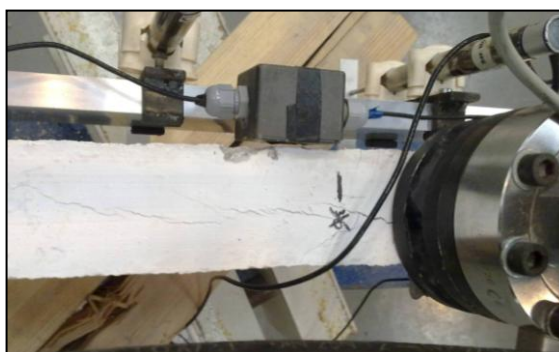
Fissuras de esforço transversal na face superior da viga V2
